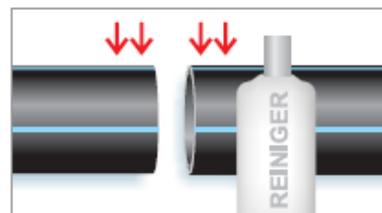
Reinigen der bearbeiteten Oberfläche des Mediendruckrohres
